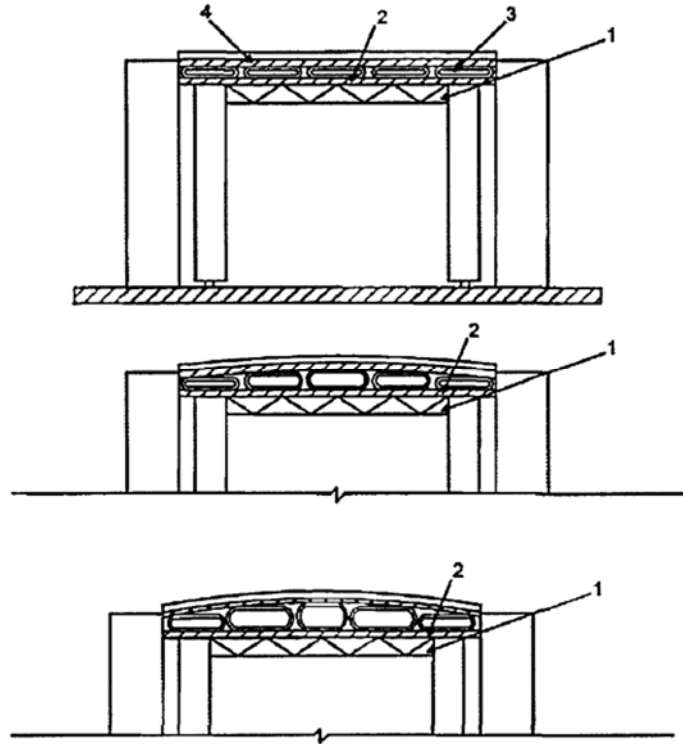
Опалубка для бетонування перекриттів
